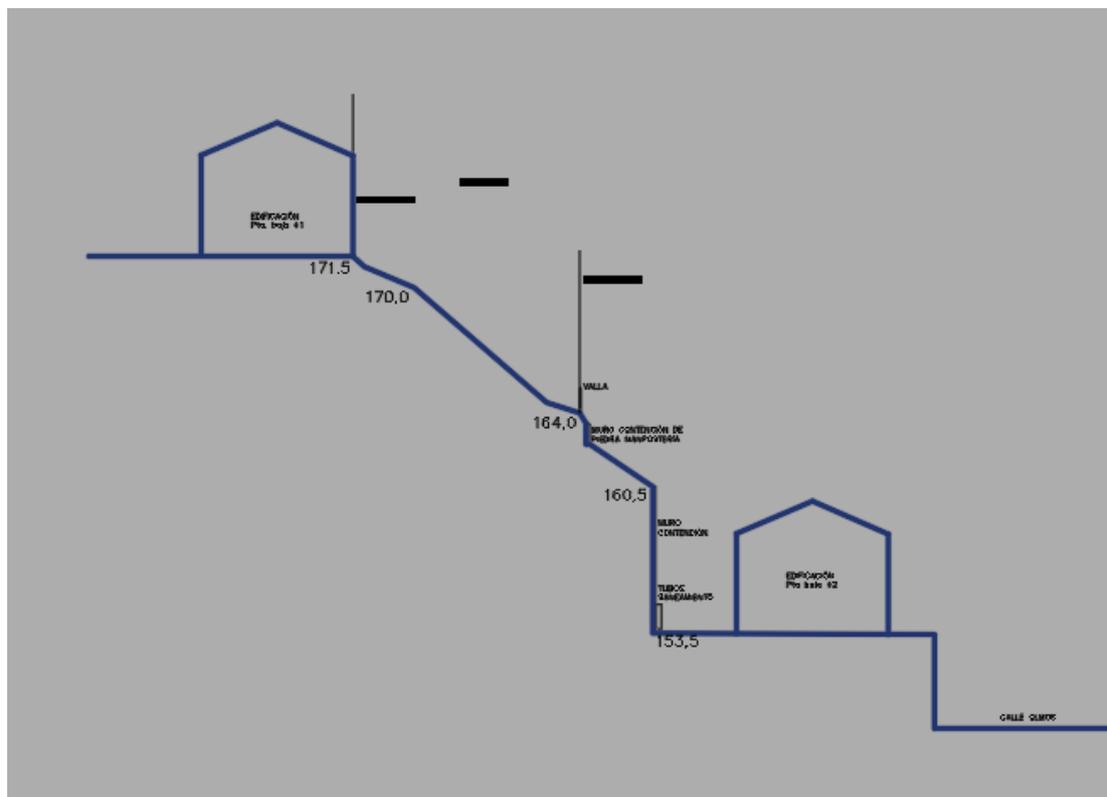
Sección con indicación de los niveles de las distintas construcciones
